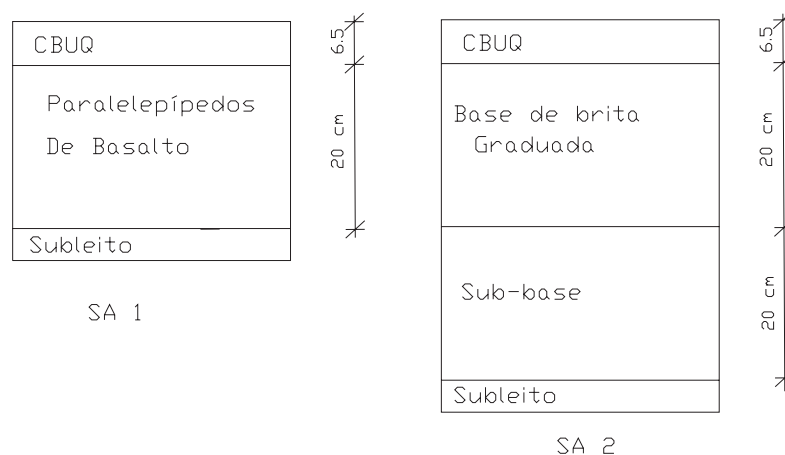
Pavimentos-tipo da SA 1 e SA 2
